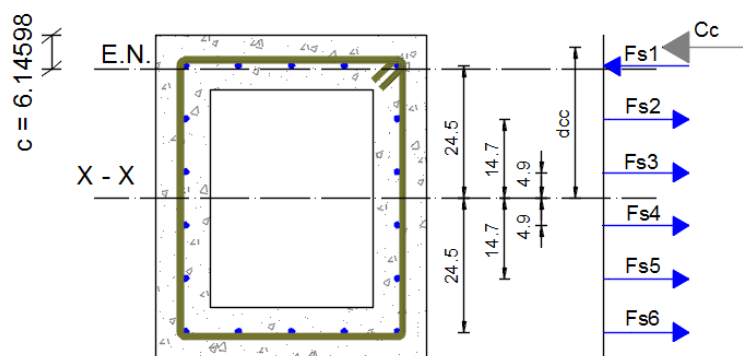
Esquema de esfuerzos y fuerzas en la sección transversal rectangular
